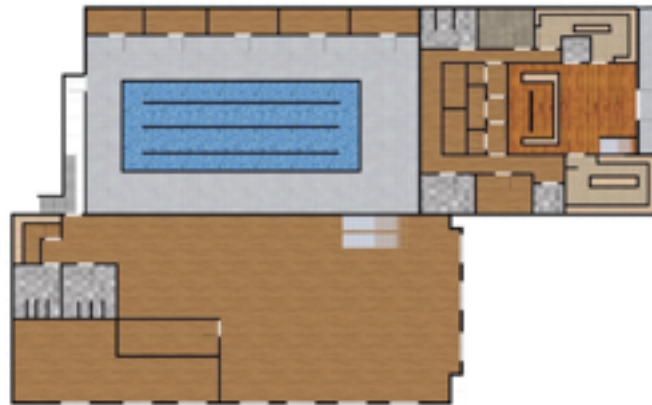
PLANTA ARQUITECTÓNICA DO ESPAÇO FÍSICO DO GINÁSIO
